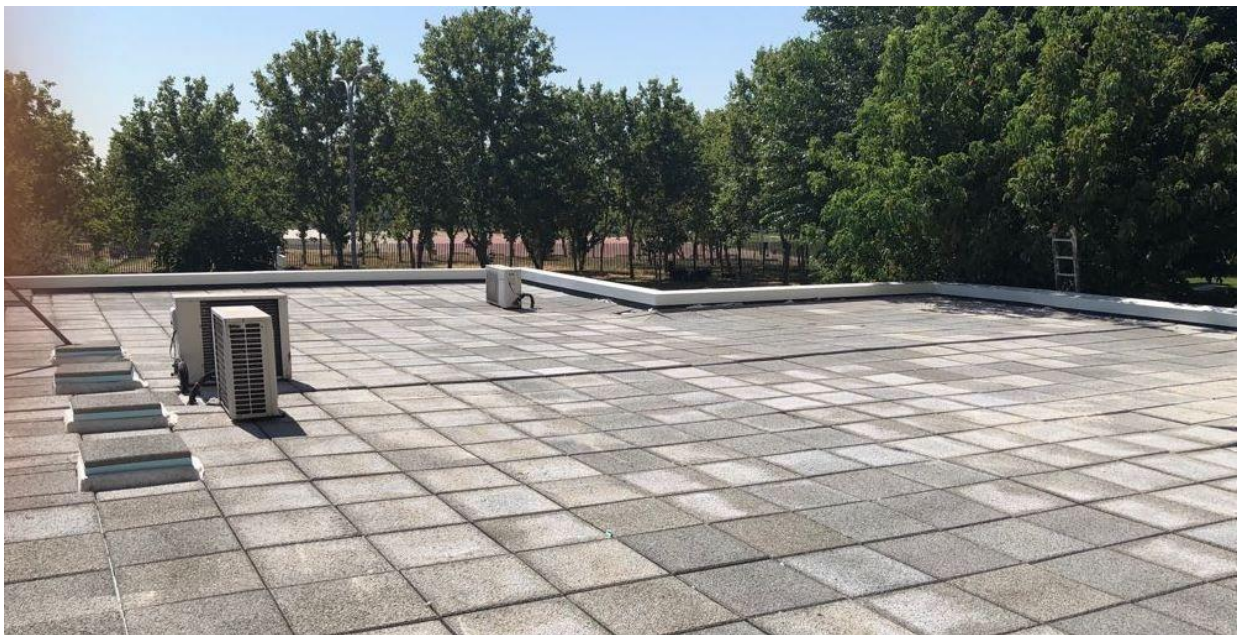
Propuesta nueva impermeabilización con pavimento flotante de baldosas aislantes
